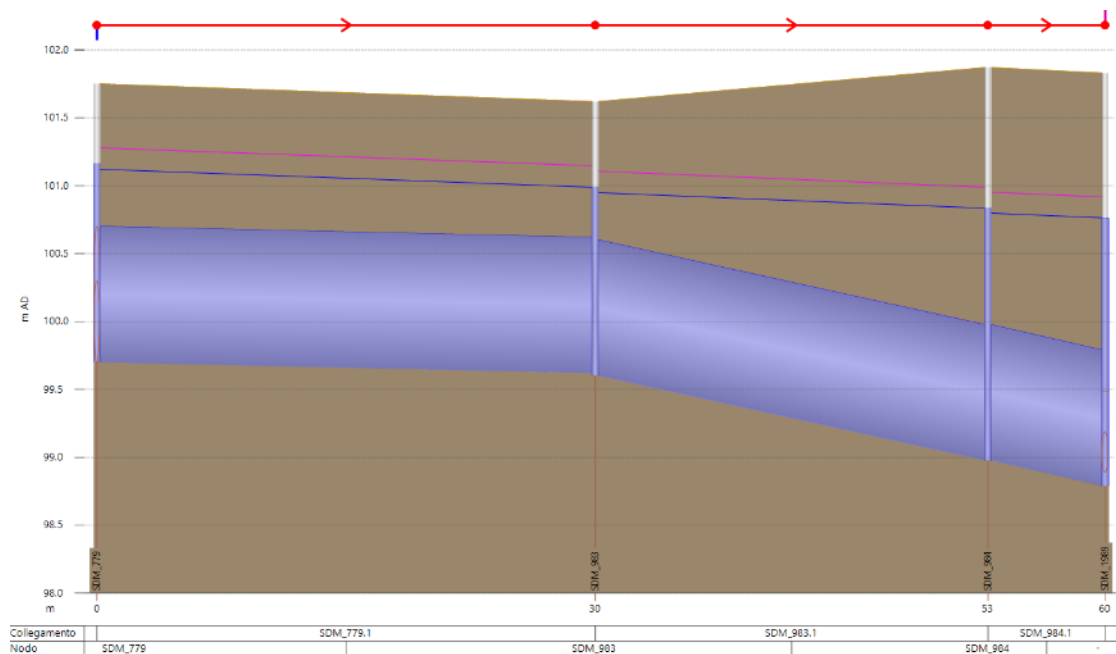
Profilo di progetto tratto di dorsale Est
